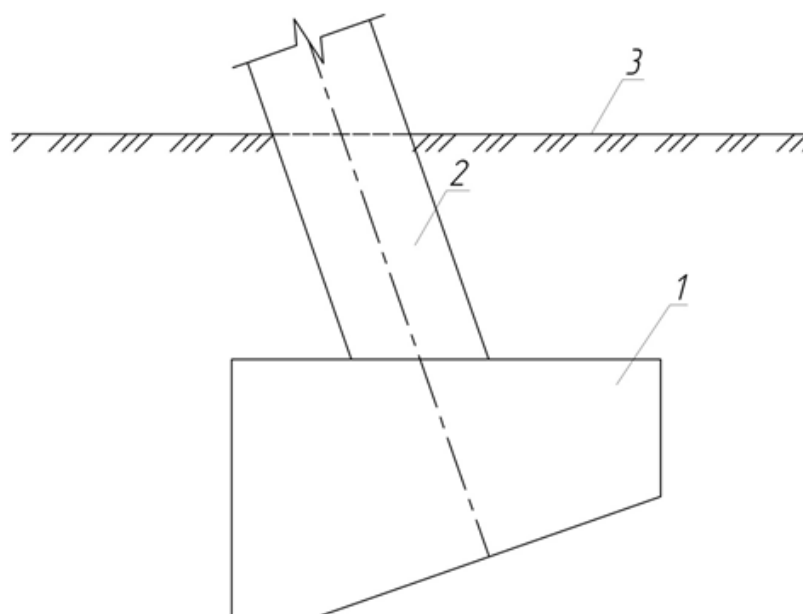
Общий вид монолитного фундамента с наклонной подошвой.
